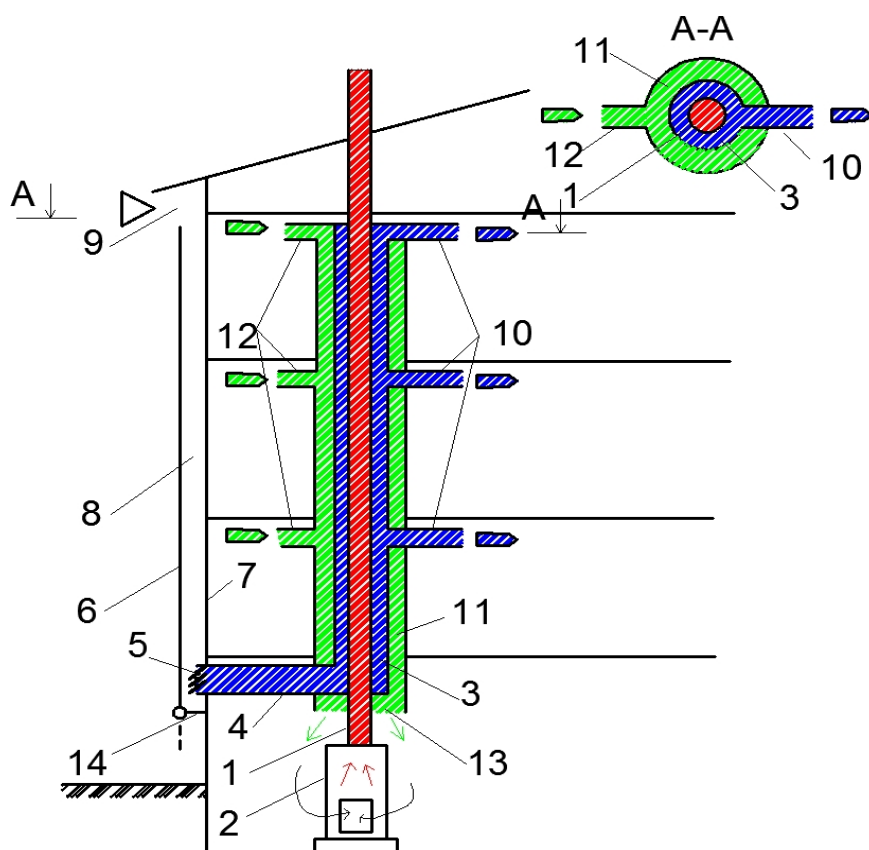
Комбинированное устройство приточно-вытяжной вентиляции с утилизацией тепловых выбросов в малоэтажных зданиях с индивидуальными отопительными котлами и навесными вентилируемыми светопрозрачными фасадными системами
